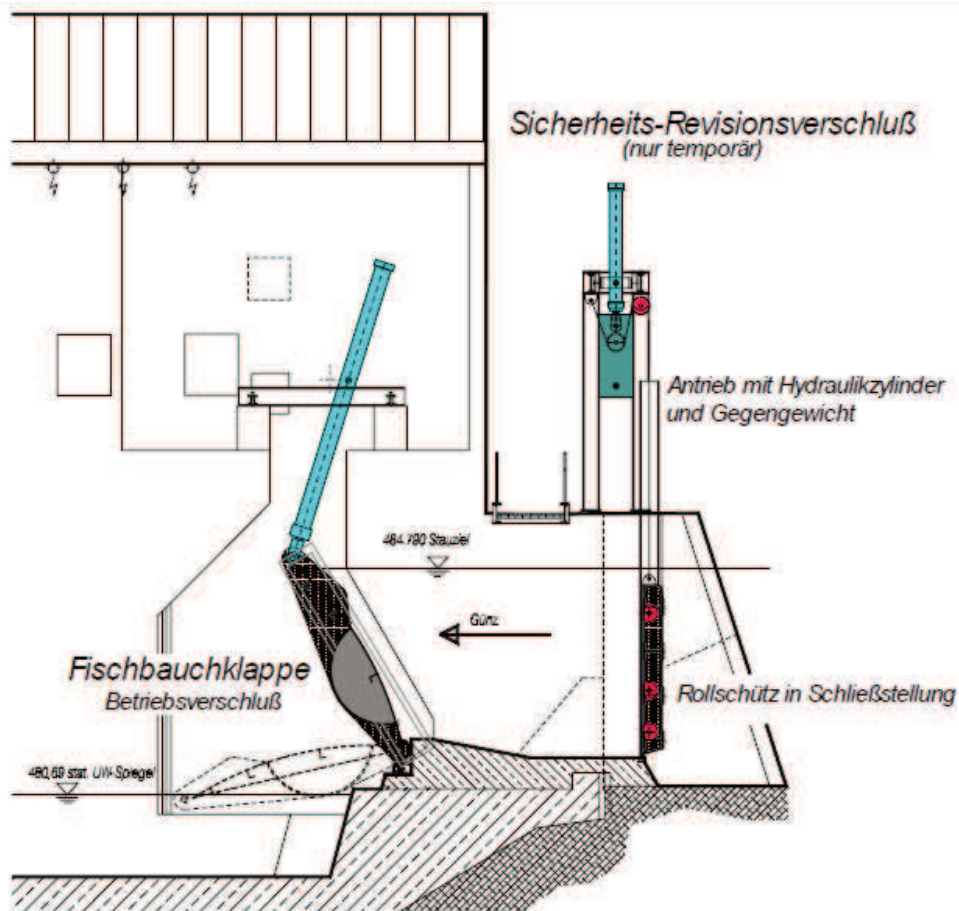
Darstellung offener und geschlossener Stellung eines Wehres ausgerüstet mit Fischbauchklappe [18]
